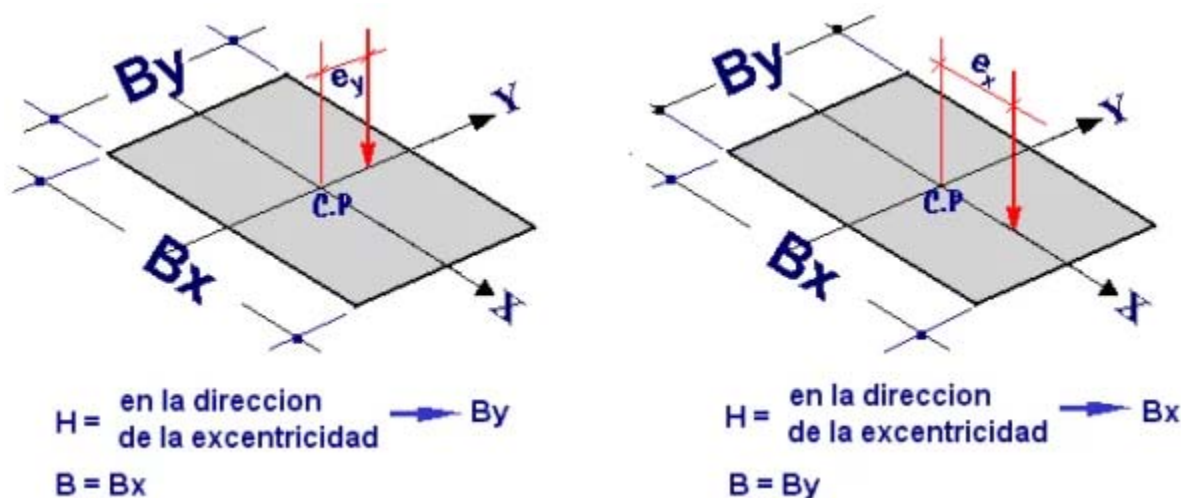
Área transversal de una columna en donde se le aplican cargas con excentricidades en el eje Y y en el eje X, ambas son uniaxiales.
